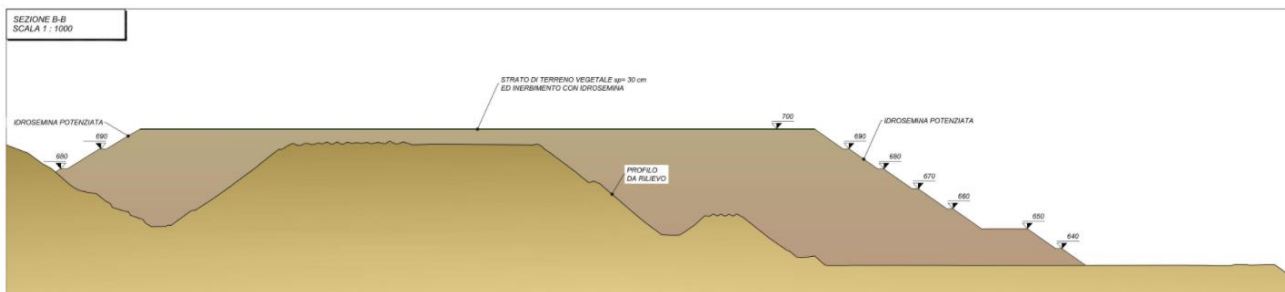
Opere a verde – Sezione di progetto deposito di Hinterrigger.
